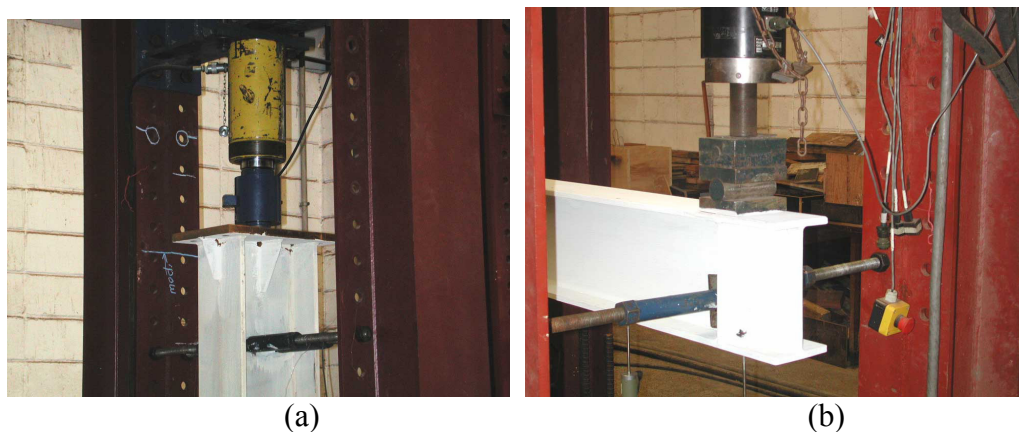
Detalhes do ponto de carregamento do pilar e do aparelho de apoio do modelo CTA-C1
